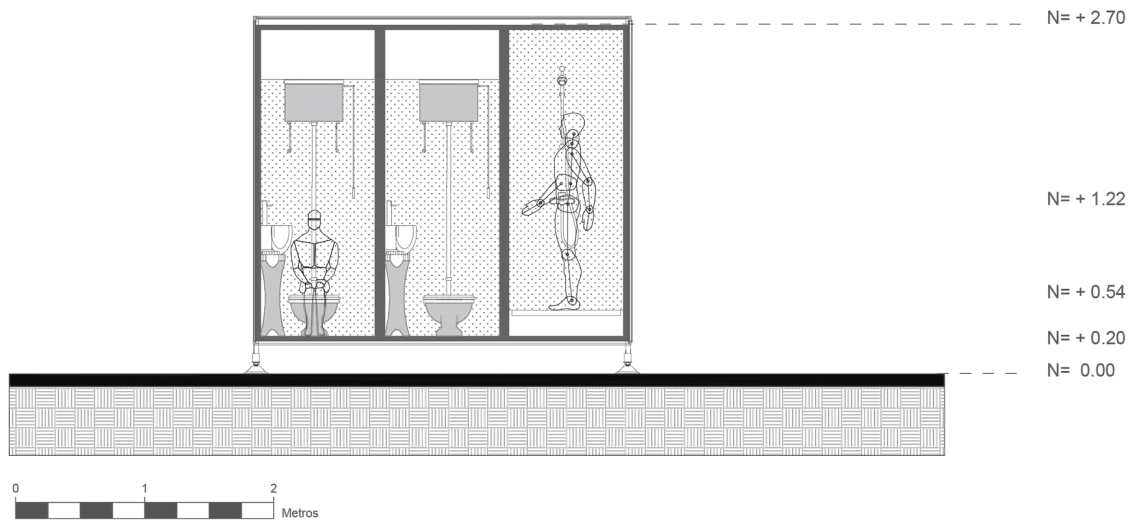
Sección A-A Zona de aseo. Elaboración: Autores. Escala 1:50
